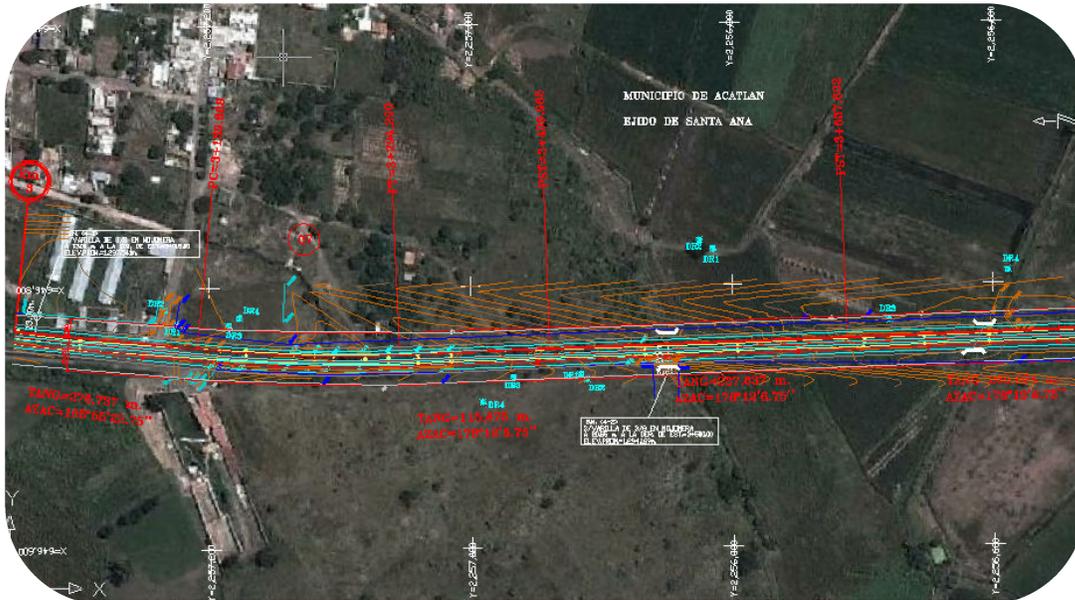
Plano de planta del km 3+000 al 4+000 tramo inicial del eje de trazo.
